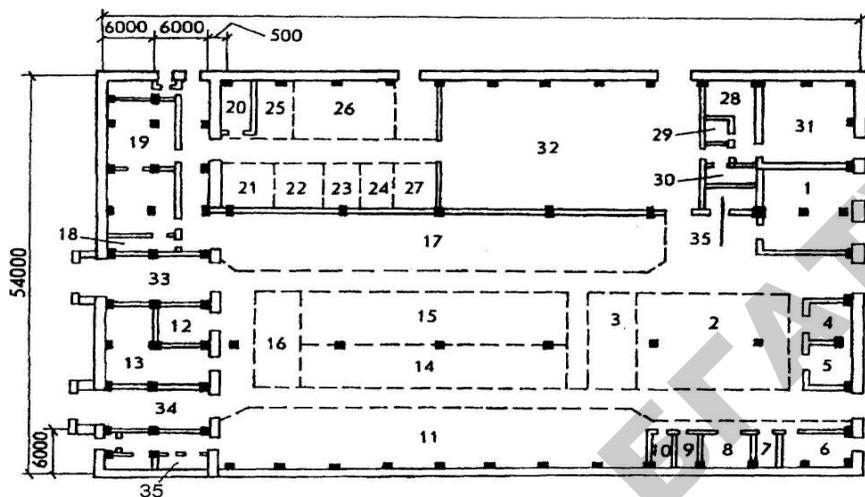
Компоновочный план производственного корпуса ремонтной мастерской общего назначения:
